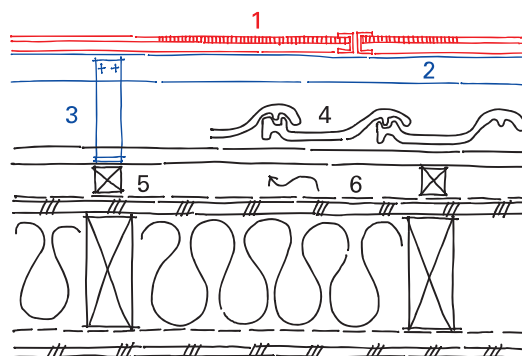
Dachaufbau bei einer integrierten und einer aufgesetzten PV-Anlage (Prinzipiskizze)
